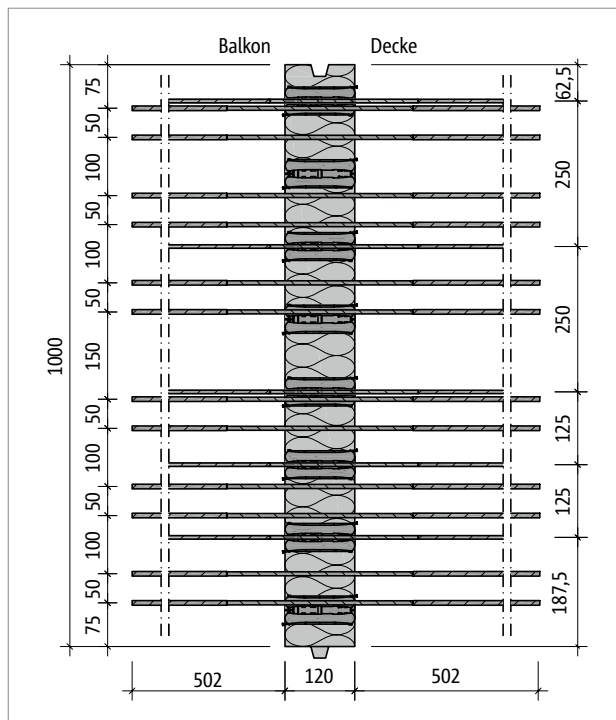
Schöck Isokorb® XT Typ KL-M4: Produktgrundriss
